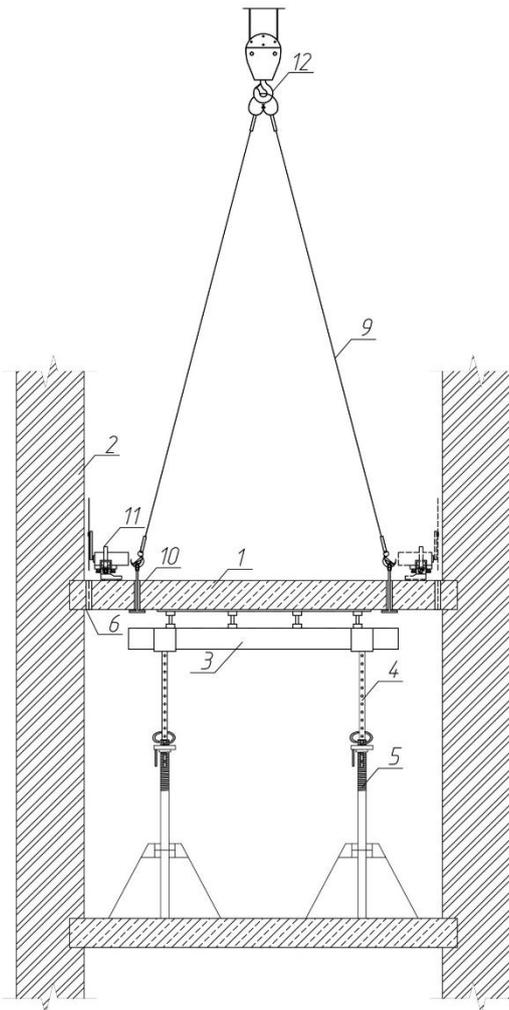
Схема резки железобетонного перекрытия алмазной дисковой пилой с его поддомкрачиванием инвентарными балками и стойками опалубочной системы
